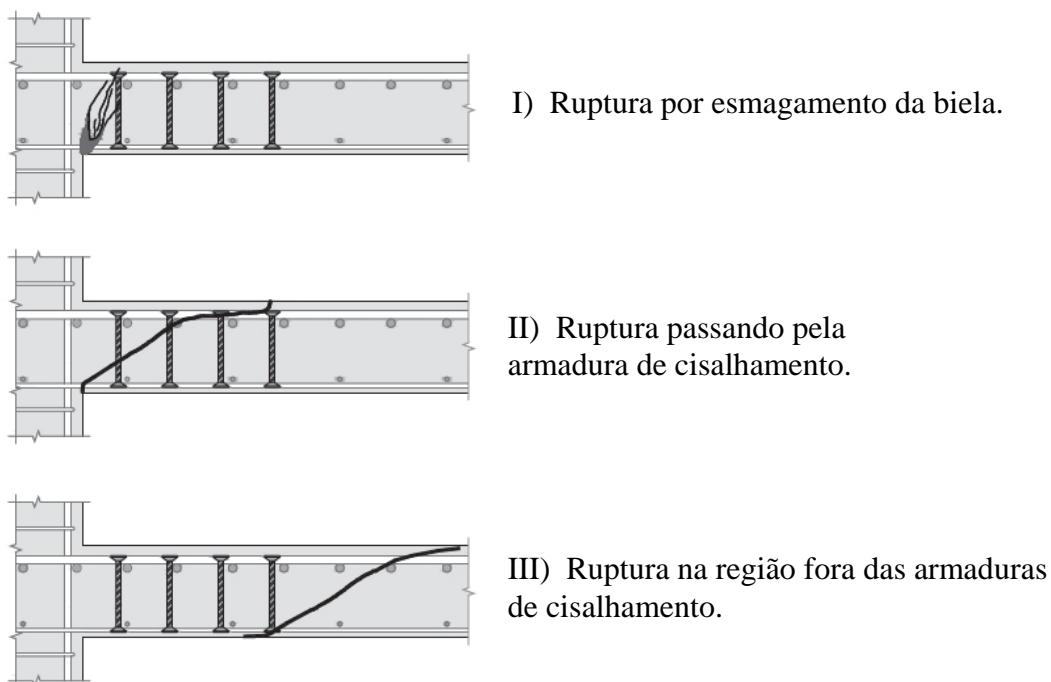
Tipos de ruptura à punção em lajes com armadura de cisalhamento.
